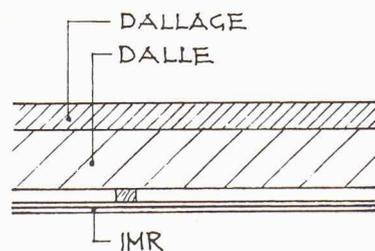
IMR sous la dalle d'un sous-sol non chauffé
